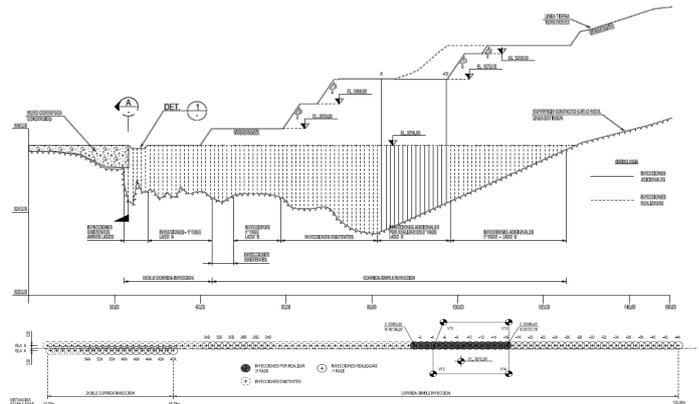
Vista en Corte Longitudinal de la Pantalla de Jet Grouting y Vista Superior de la Cortina de Columnas Secantes de Jet Grouting..
